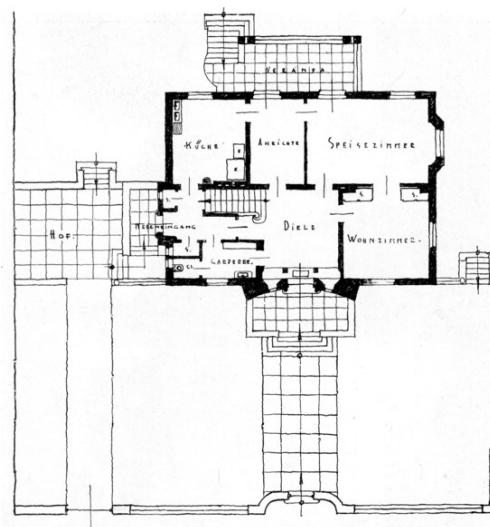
Grundriss des Wohnhauses Schlegelsberg v. d. Höhe – Arch.: Walter Furthmann
